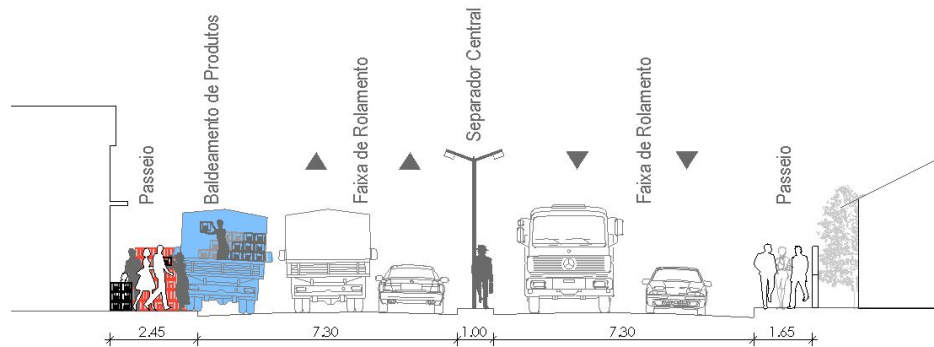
Avenida do Trabalho – situação de utilização errada durante descarregamento
